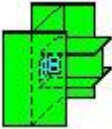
détails sur l'assemblage pied de poteau articulé.
